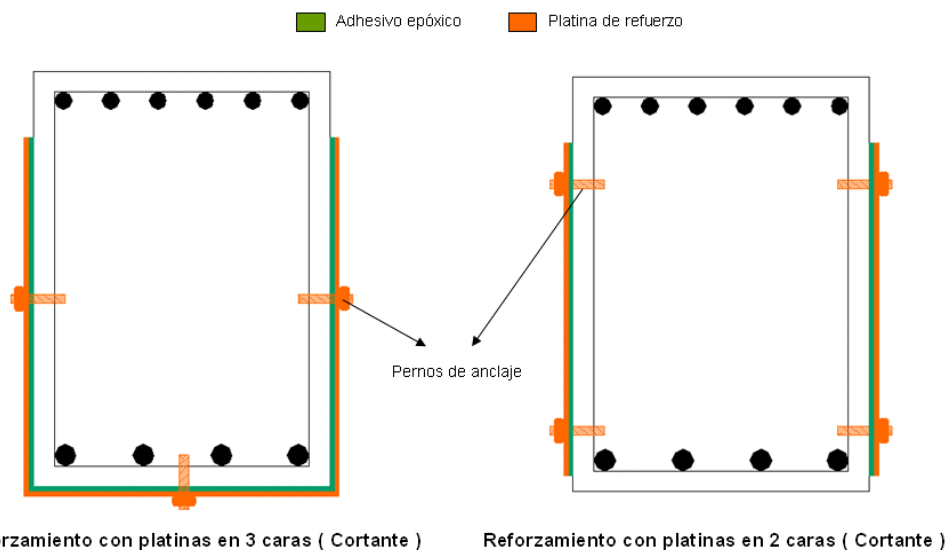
Esquema ilustrativo para el reforzamiento de vigas a cortante con platinas metálicas
